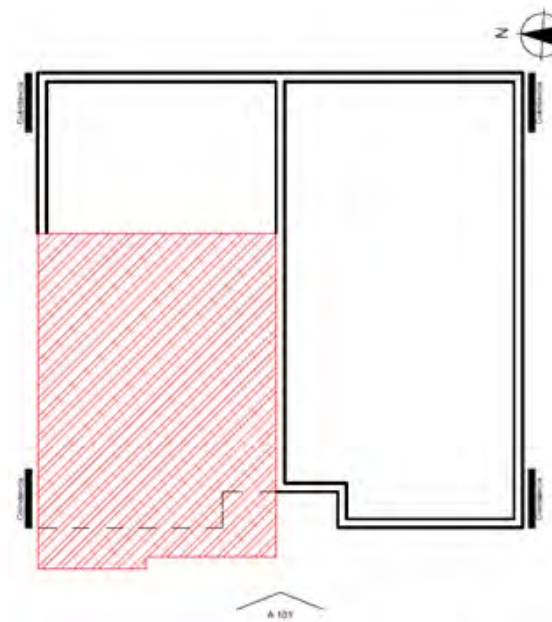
Planta del Edificio D indicando el área intervenida por la modificación. Fuente: propia 2018
